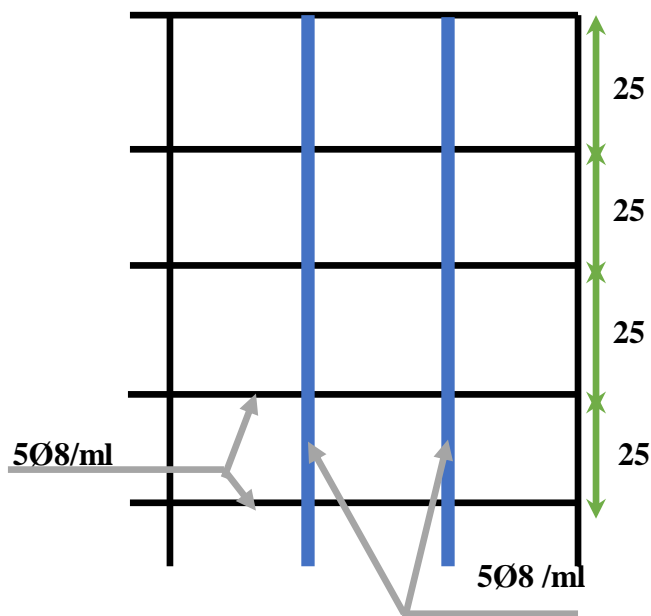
Ferrailage de dalle flottante ($e=15$ cm)
